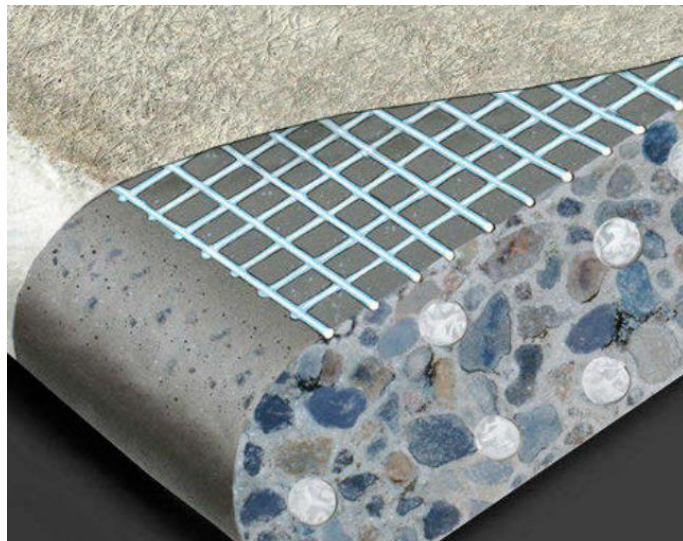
Mur-rideau en panneaux en béton composite [6]
